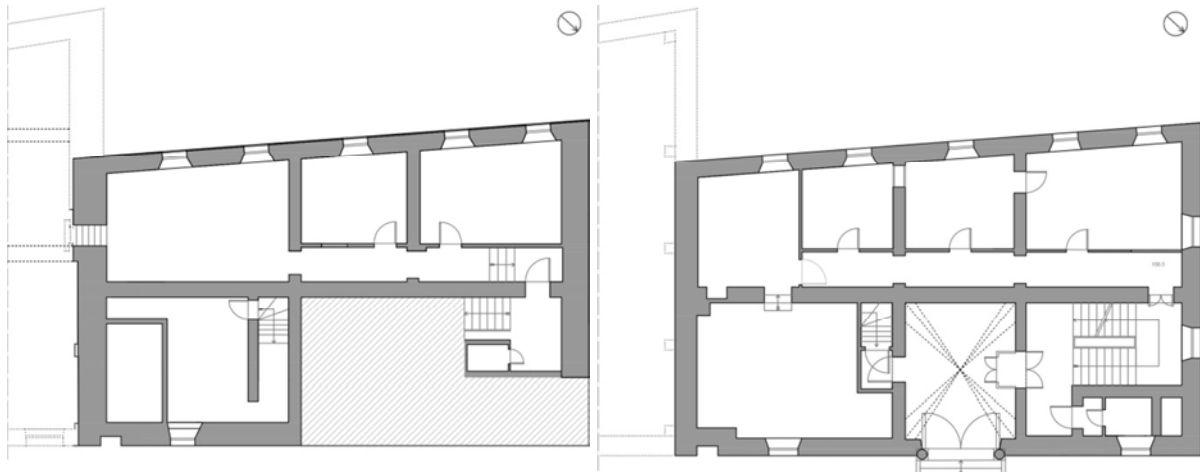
Pianta piano seminterrato e pianta piano terra.
